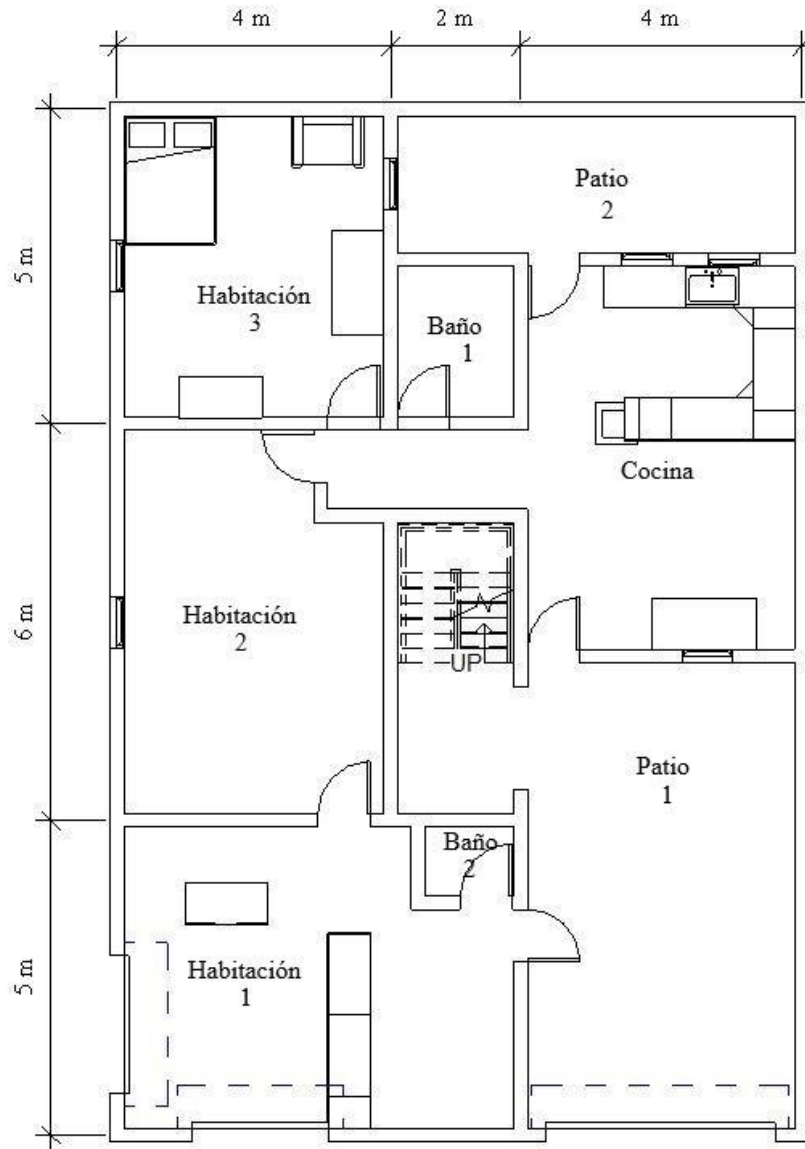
Plano arquitectónico de la edificación en la Ciudad de México, planta baja.
